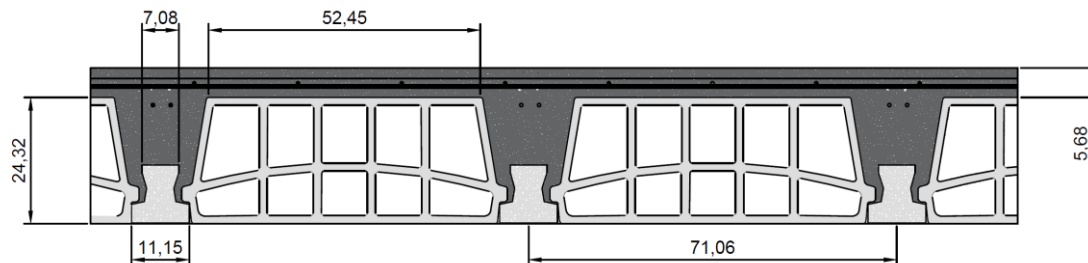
Croquis acotado de la sección del forjado. (Fuente: elaboración propia)
